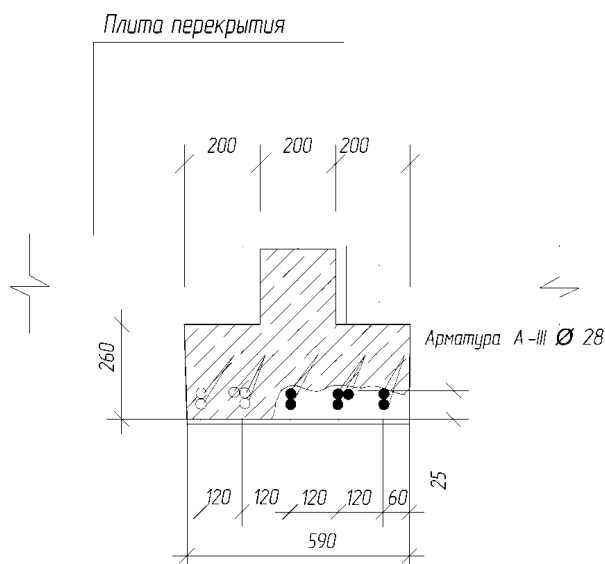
Сечение железобетонного ригеля (9 м)
